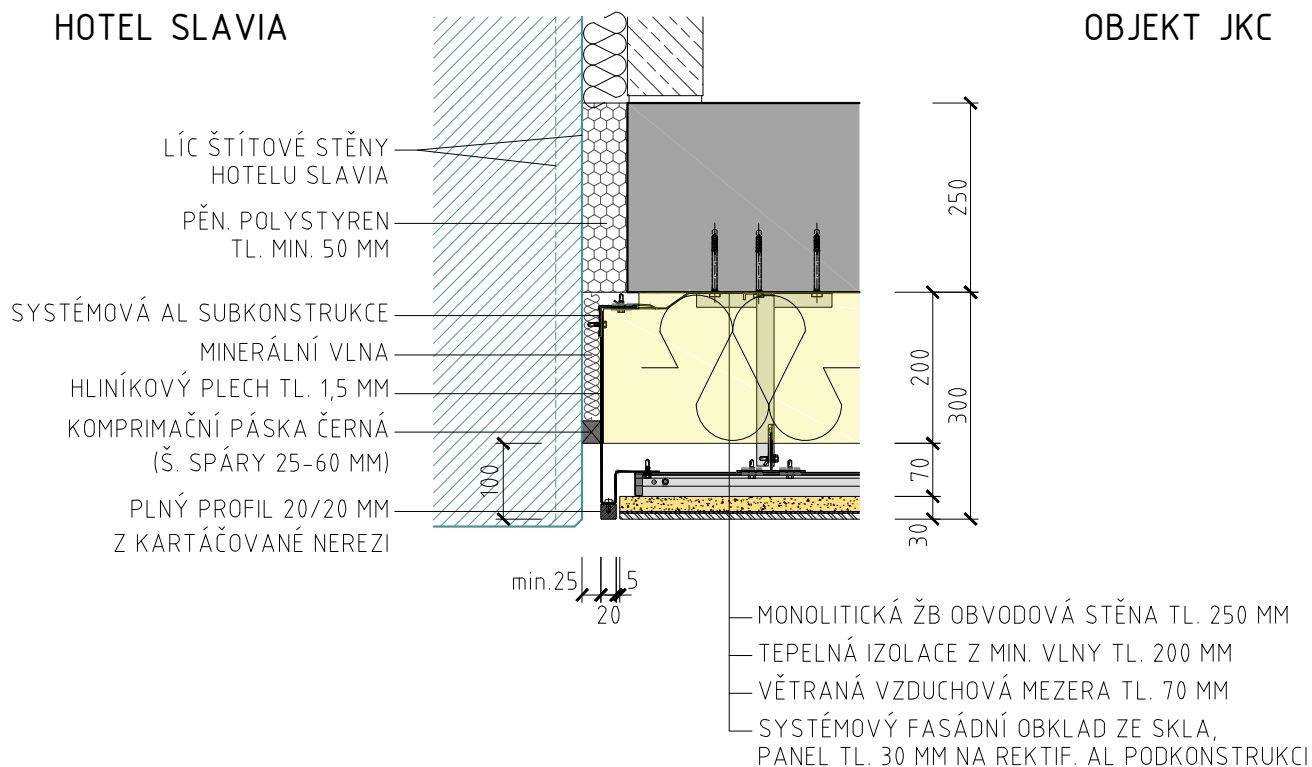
DETAILY STAV. NAPOJENÍ K SOUSEDNÍM OBJEKTŮM
